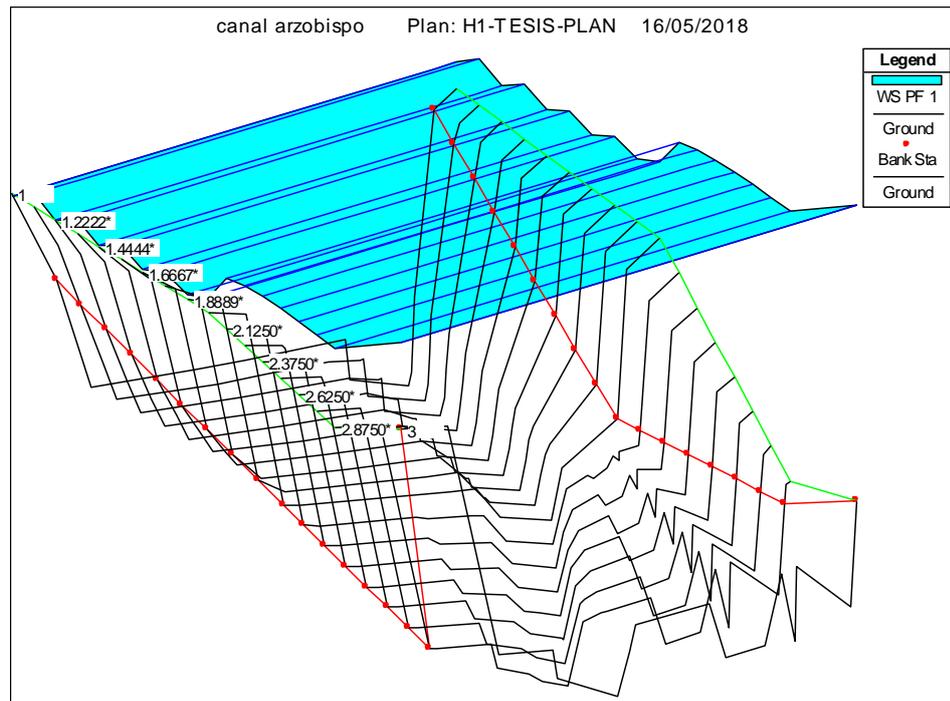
Perfil Perfil de flujo canal Río Arzobispo (Estructura completa) (condición actual) H1
